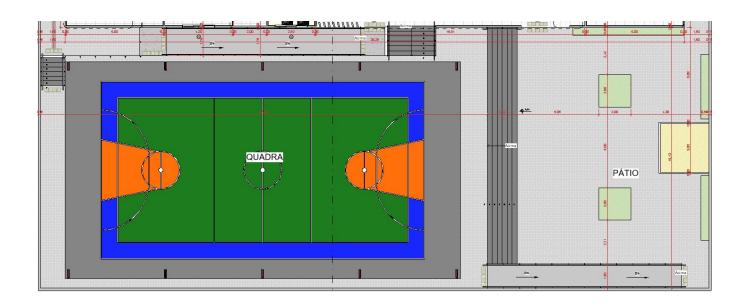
Planta Baixa Bloco B – Pedagógico
